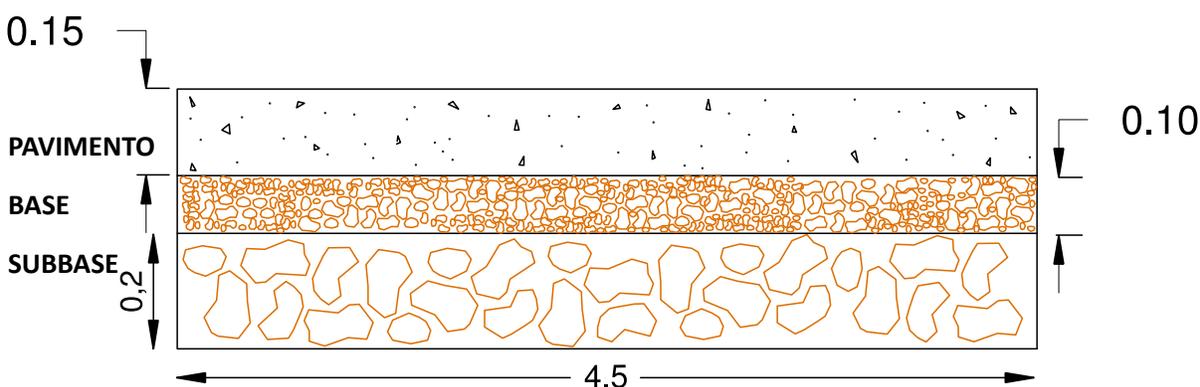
Diseño de la subbase, base y pavimento rígido. Fuente: Elaboración propia.
